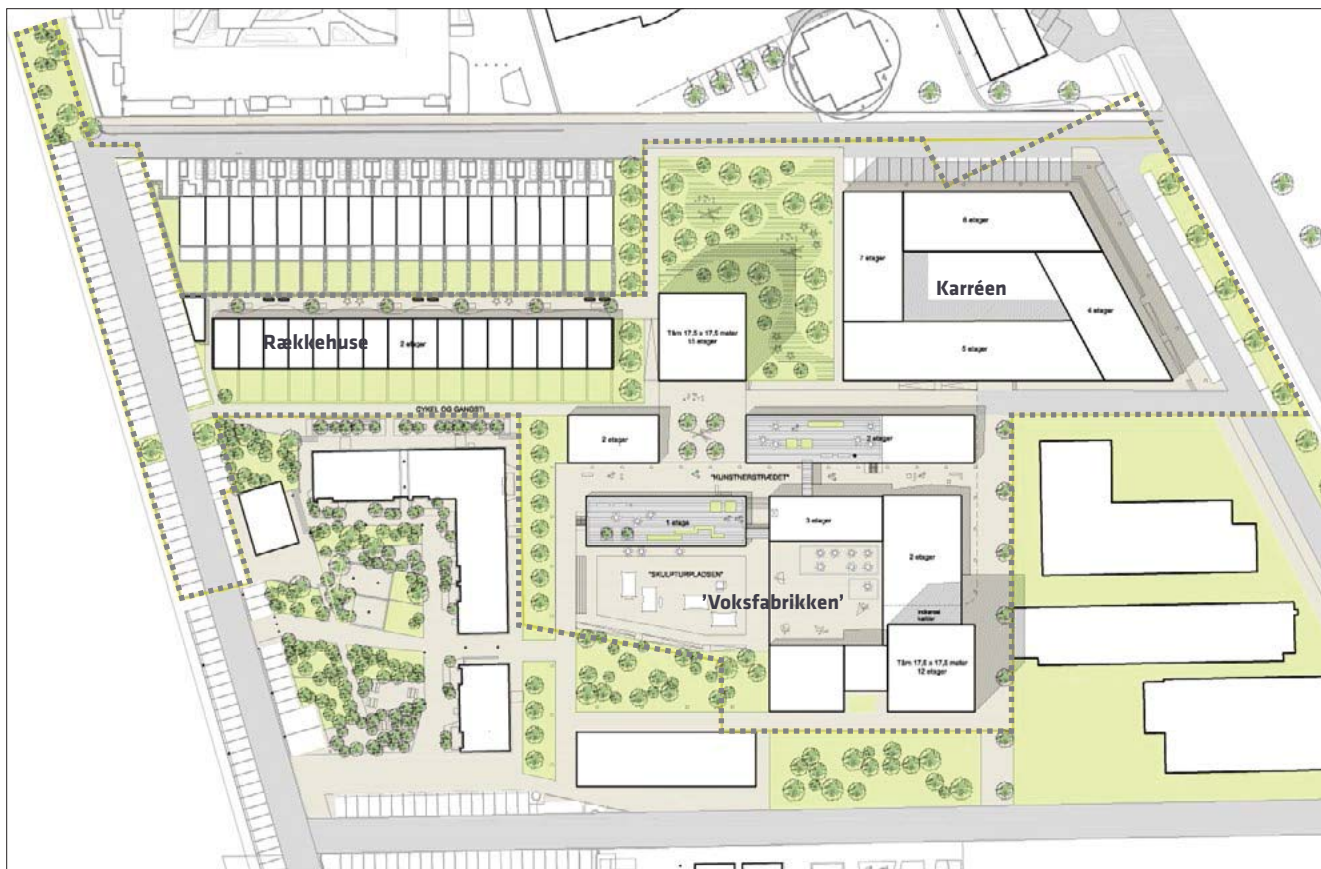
Illustration nr. 1 visende lokalplantillæggets bebyggelsesplan.
